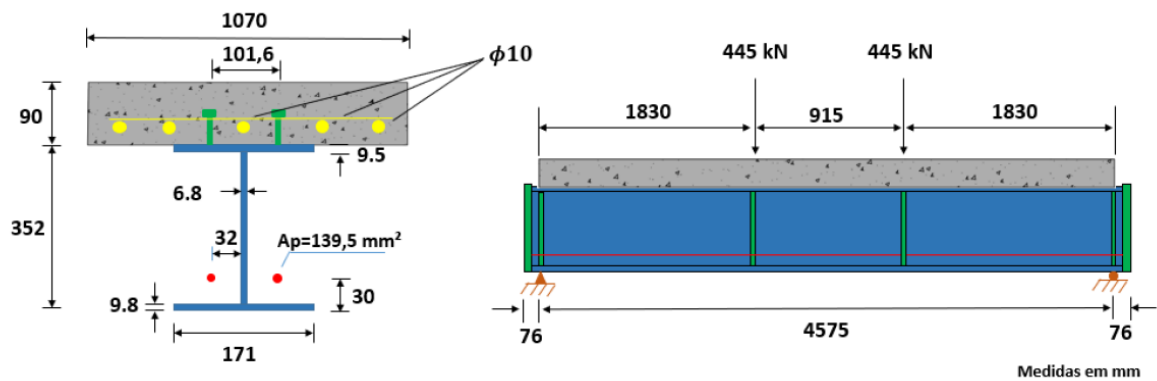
Detalhes da viga VMP1 (SILVA, 2018).
